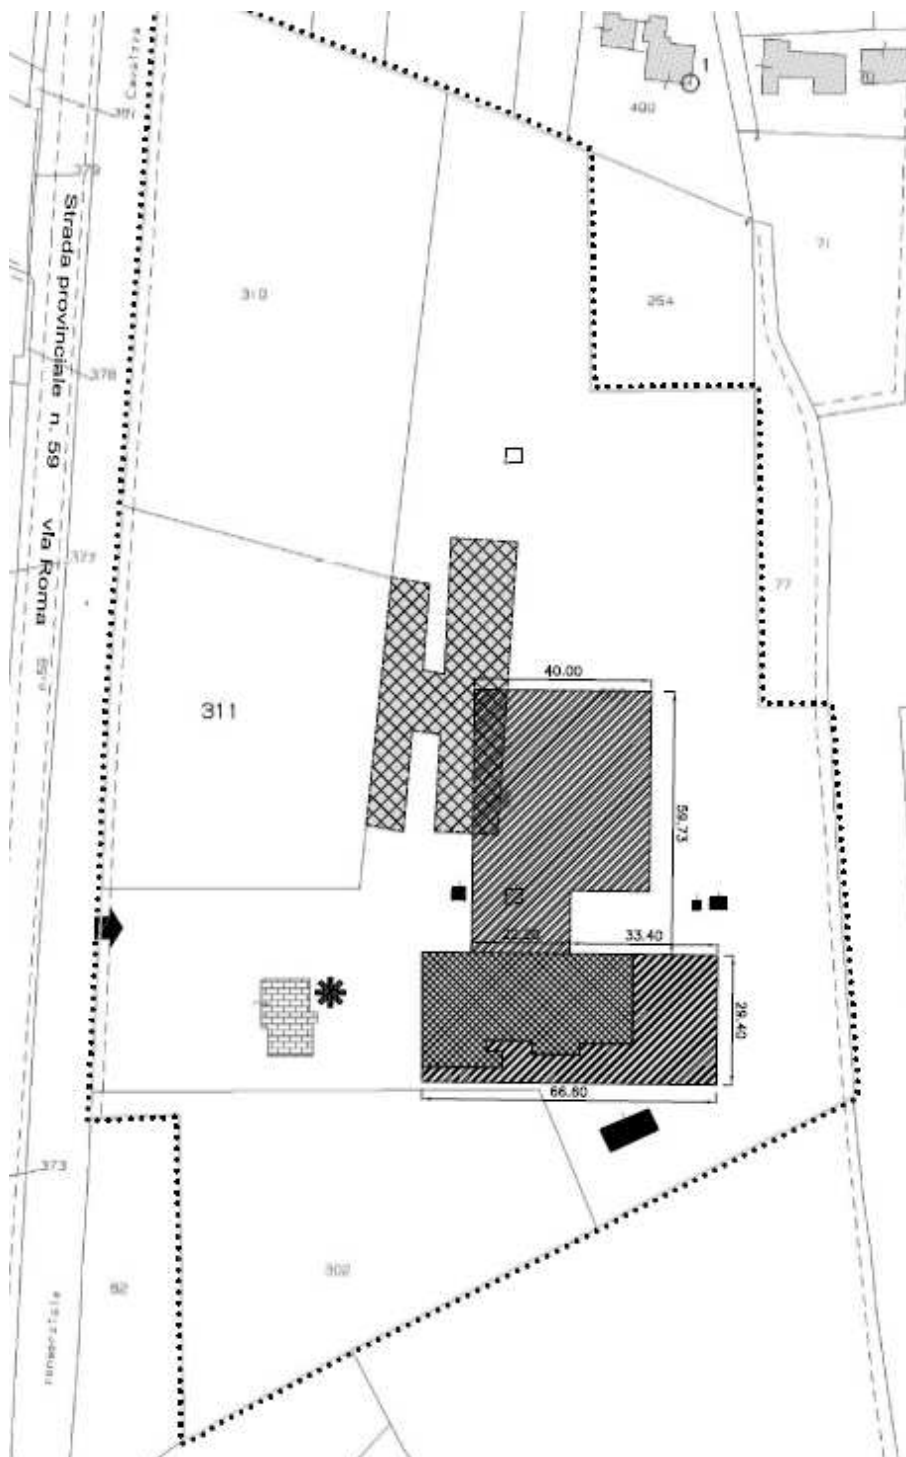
/3/a – “Scheda 21” LR 11/1987. Planimetria
